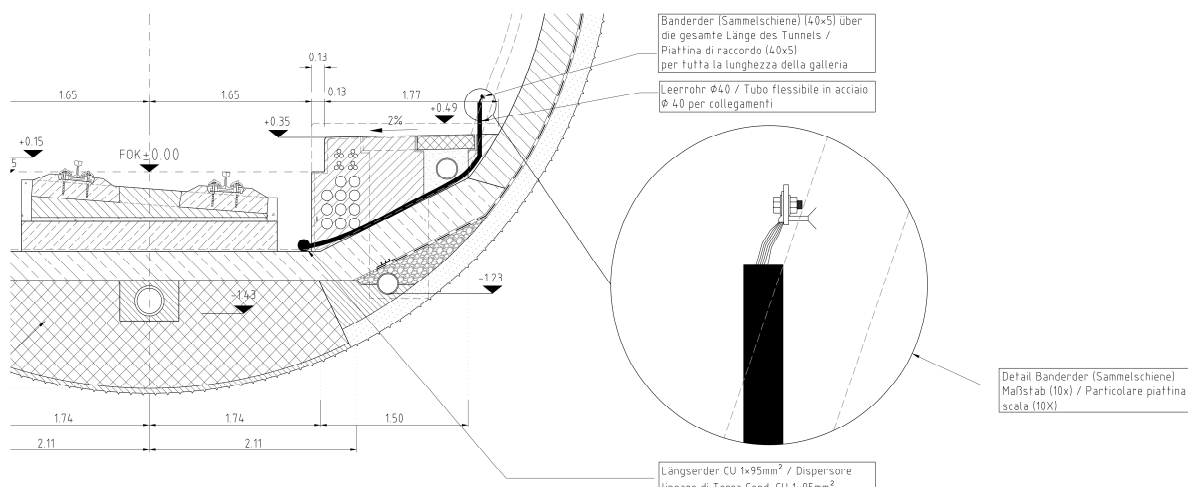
Schematische Detaildarstellung des Anschlusses an den Längserder
